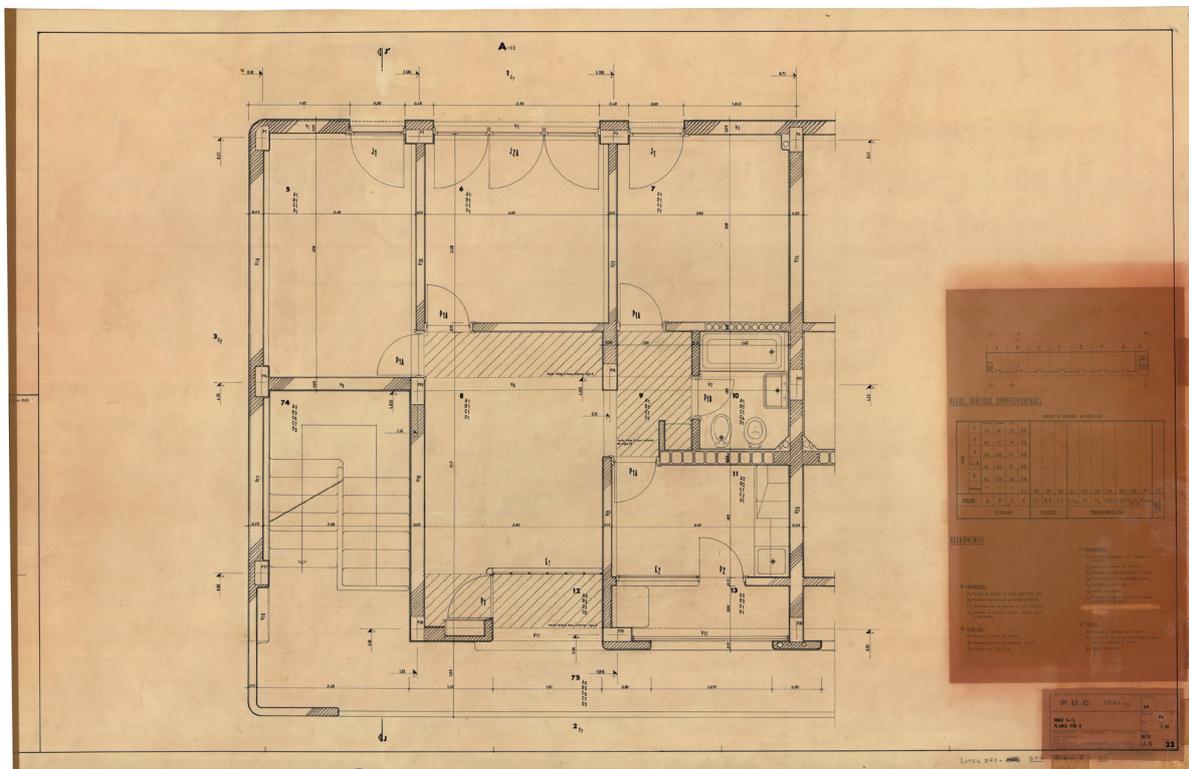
Projeto: lote 249, troço A – T3, planta piso 9
